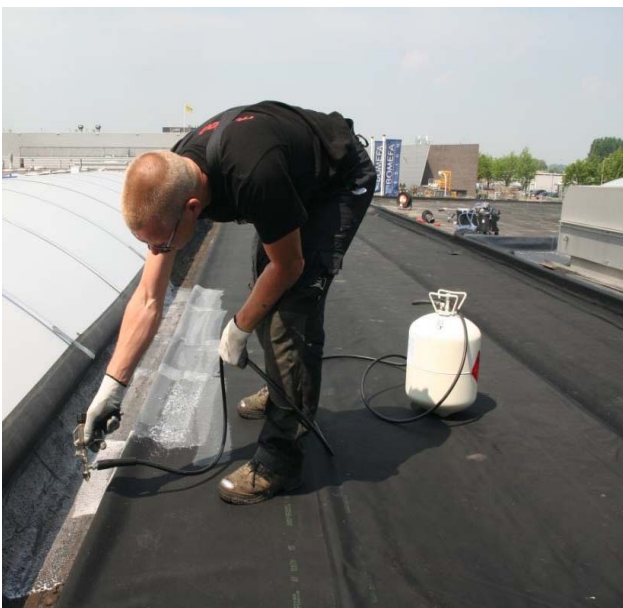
Collage du relevé à la colle HERTALAN KS 205 (pulvérisation de la colle)
